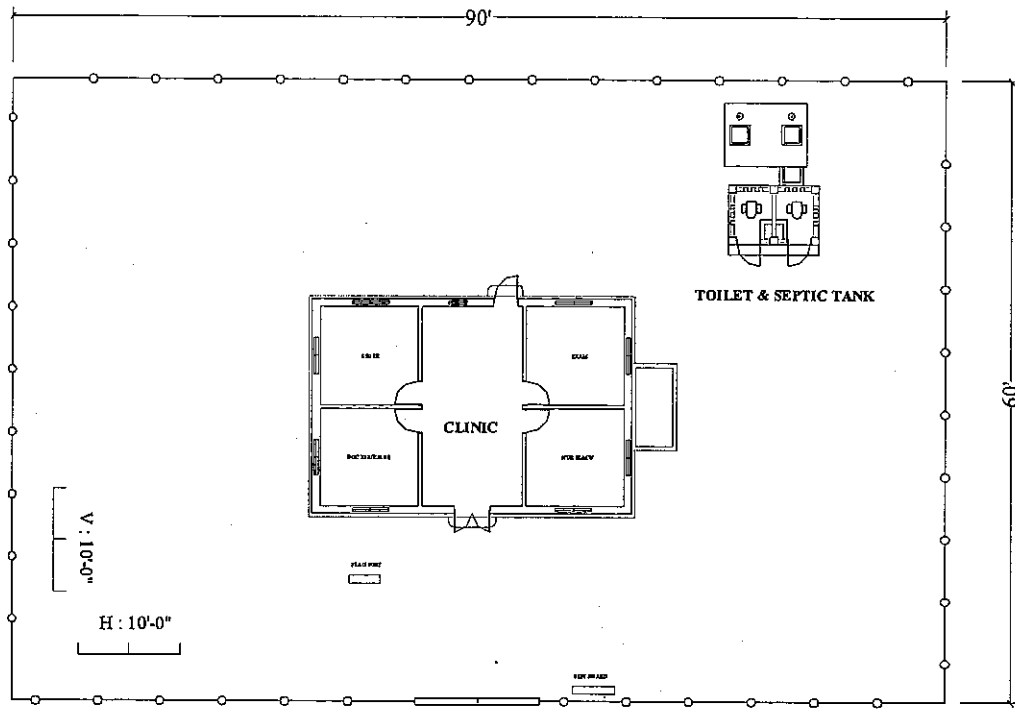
シャウカイ村保健クリニック施設整備計画平面図
